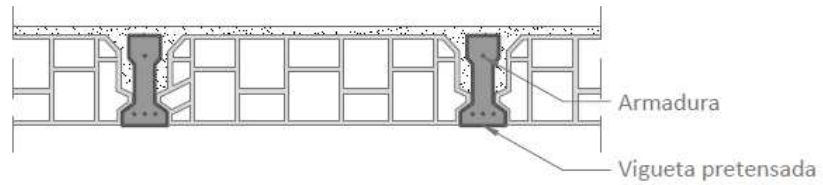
Detalle de forjado de viguetas pretensadas y bovedilla cerámica plana con capa de compresión.
